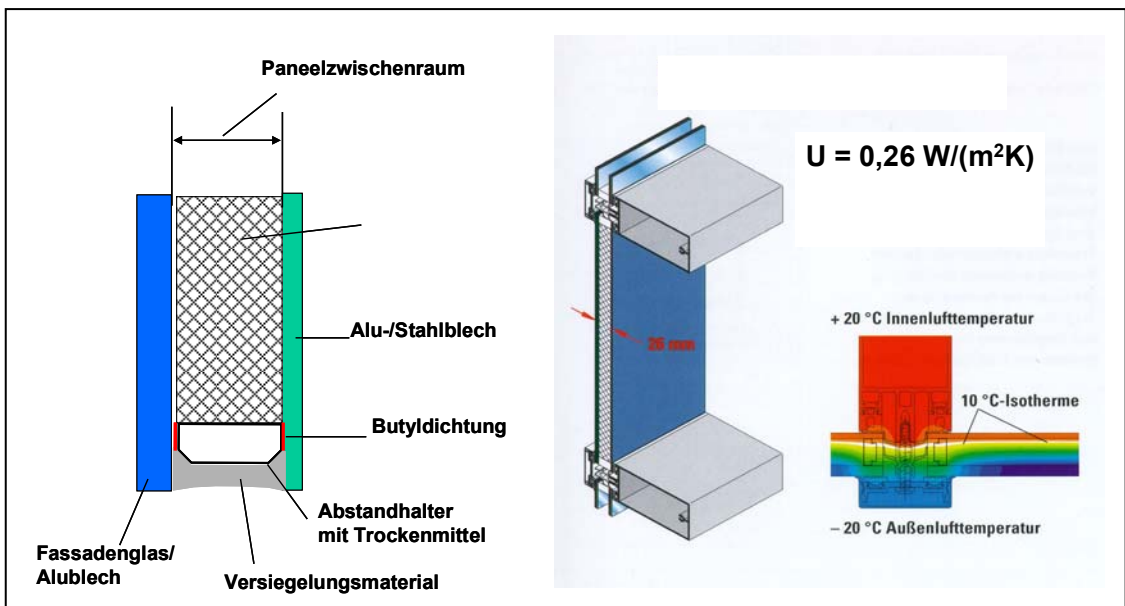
Schüco VacuTherm. Ein Fassadensystem mit VIP in den Brüstungspanel.
